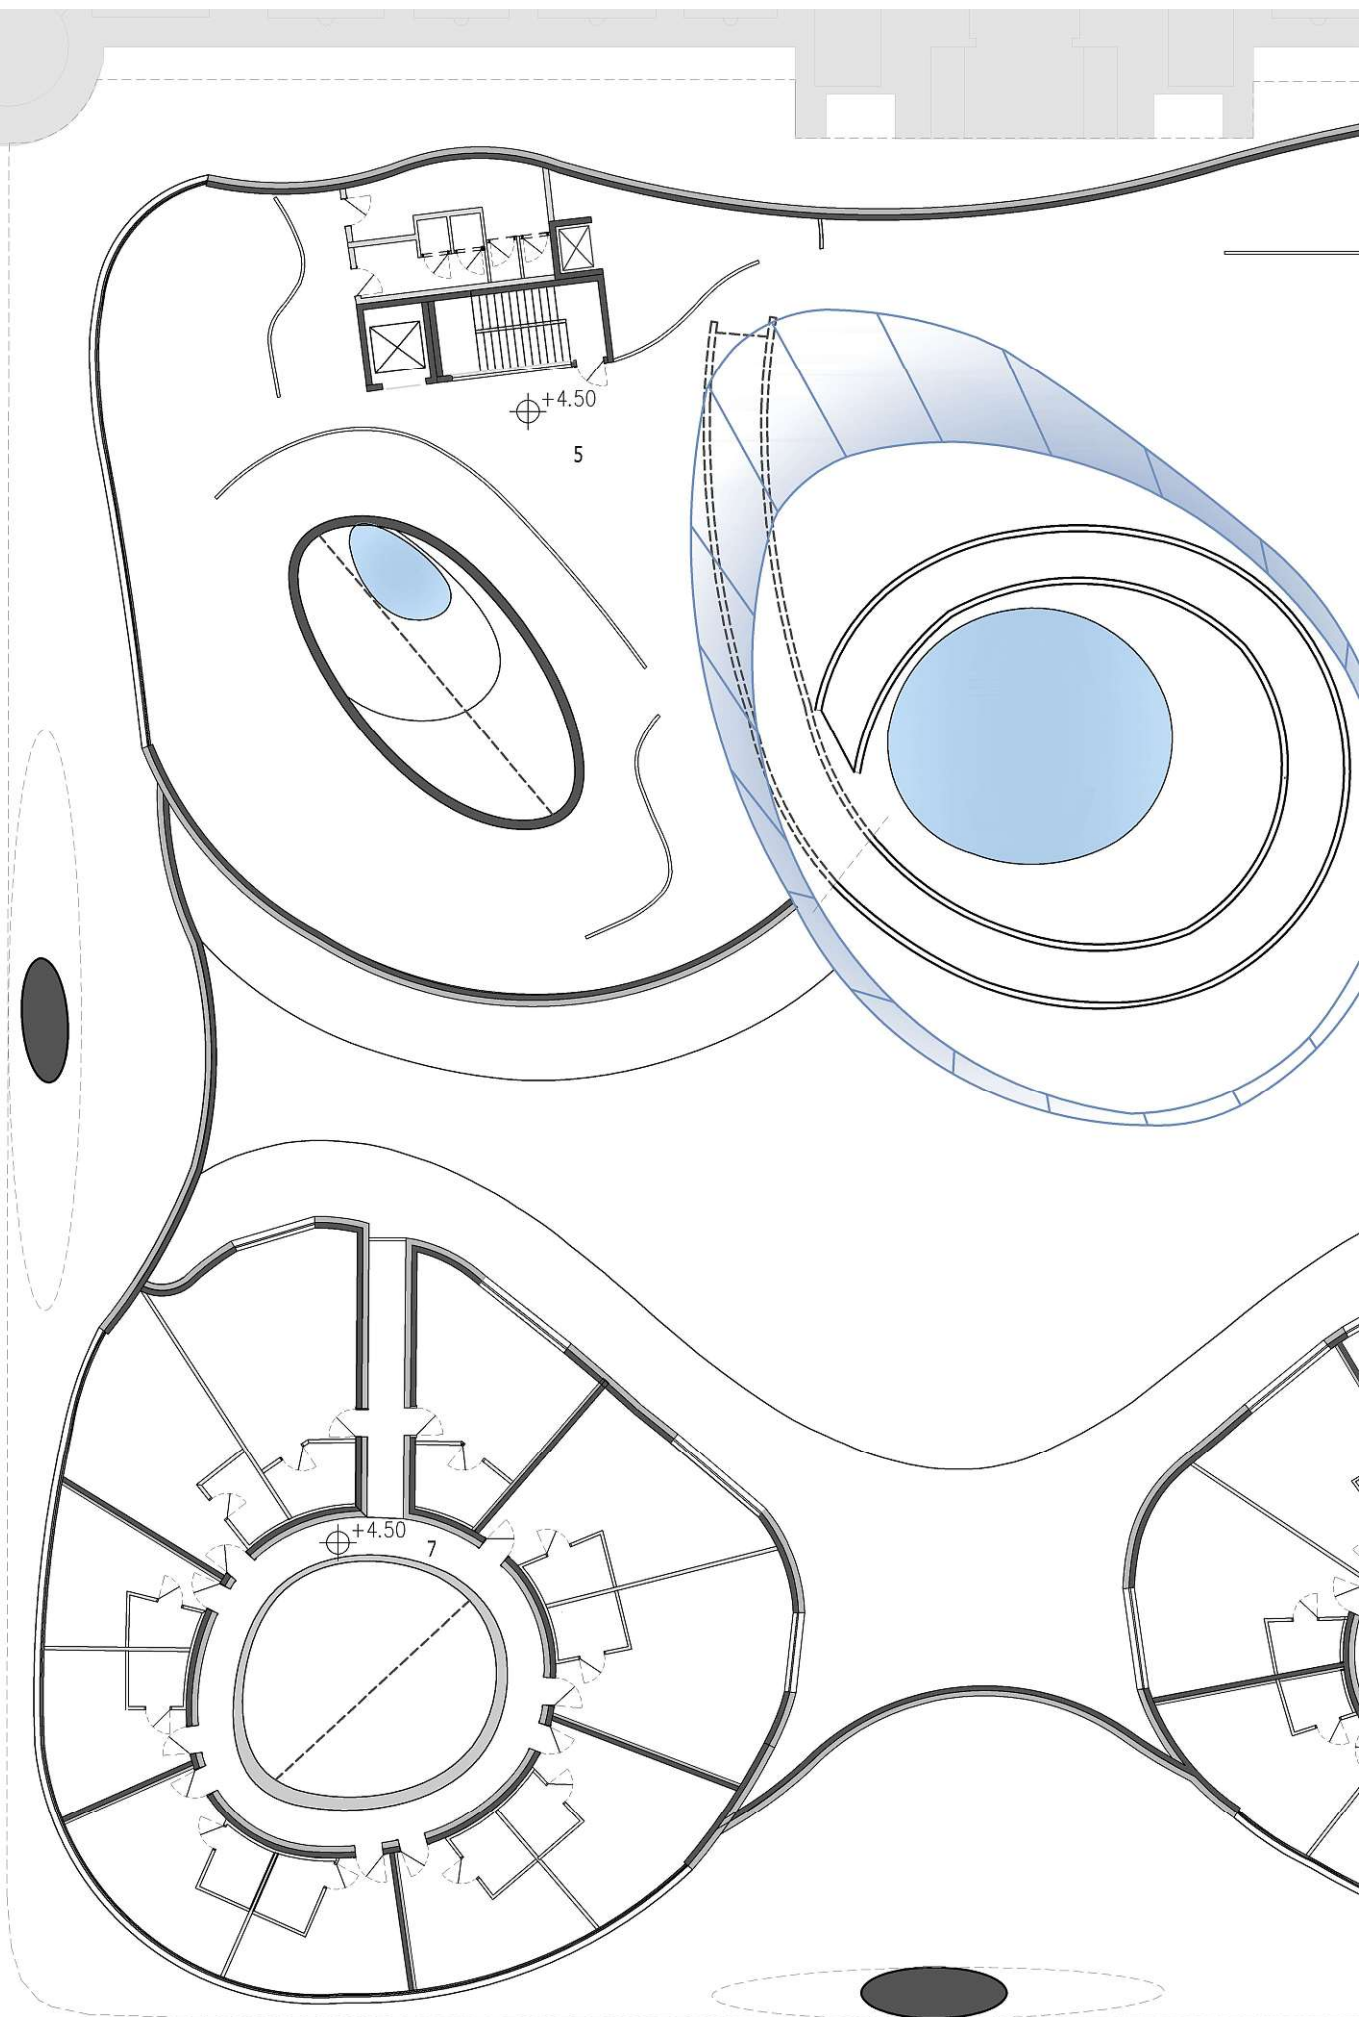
Übersichtsplan Erstes Obergeschoss
